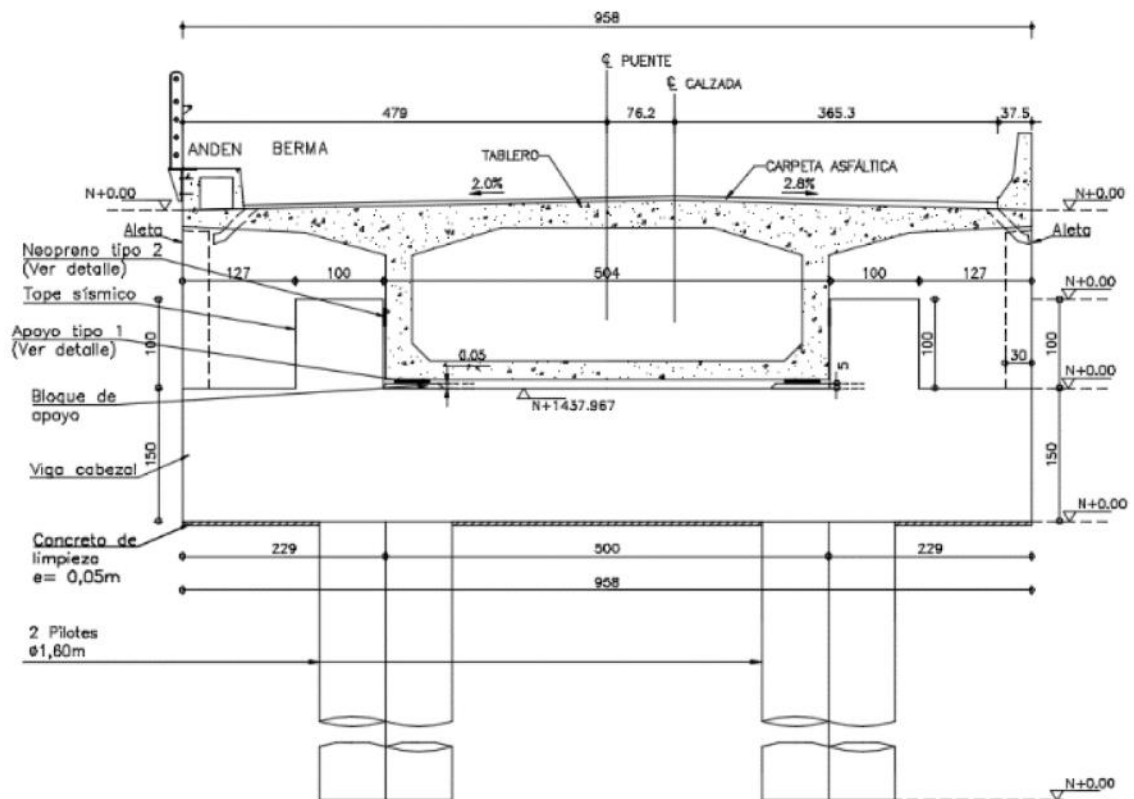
Geometría del apoyo eje 1 y 4 del puente Bermúdez.
